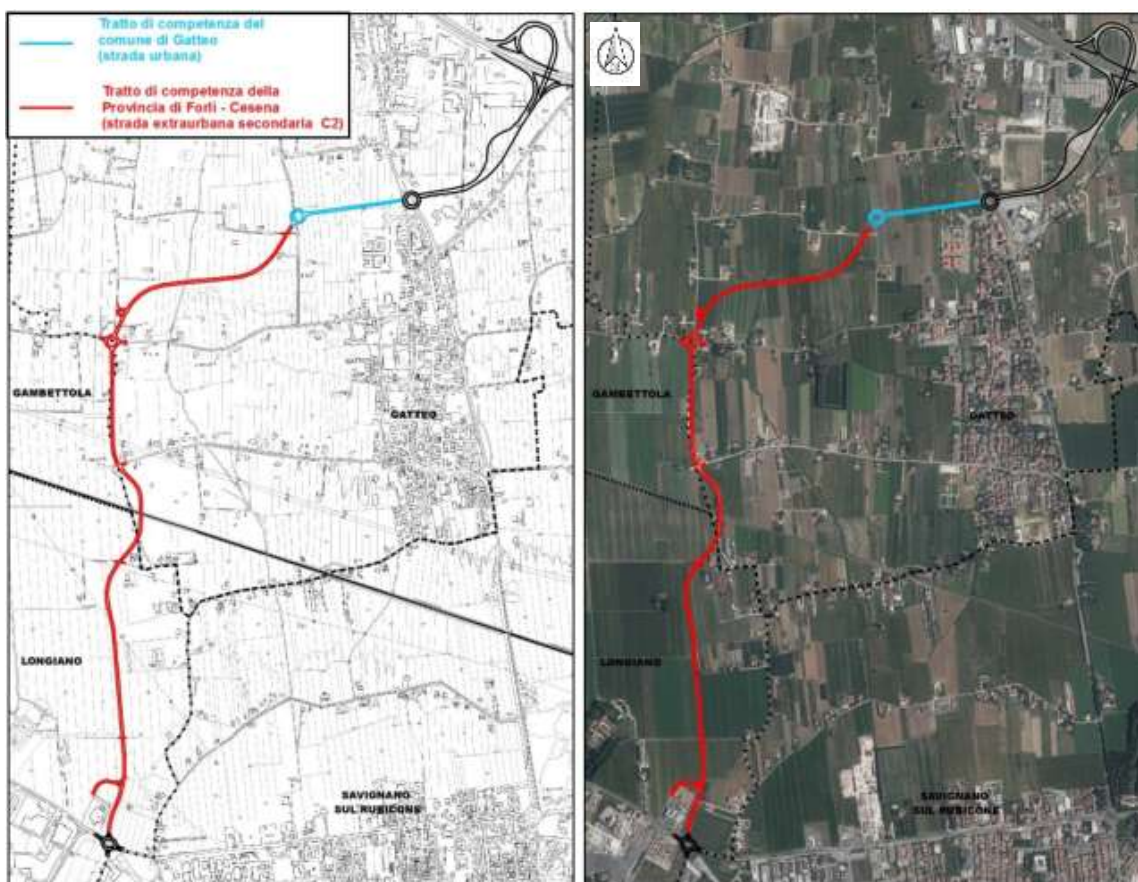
a – planimetria di progetto nuovo collegamento stradale su CTR (a sinistra) e su ortofoto (a destra)
